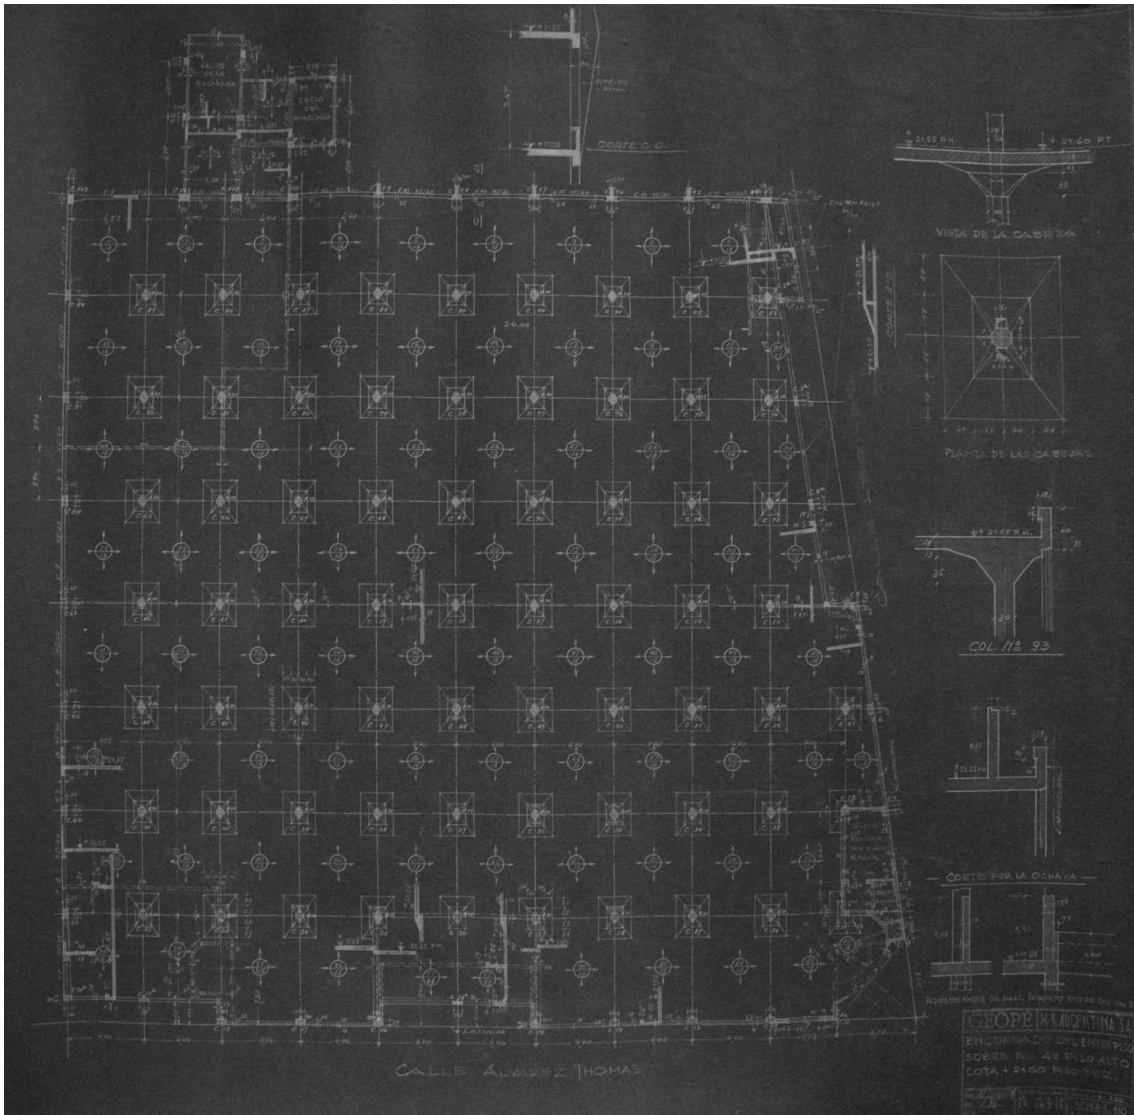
Planta da Fábrica Algodonera Argentina, no canto direito se observa os detalhes da concepção estrutural como da laje cogumelo e da viga invertida que serve de vedação. Fonte: Acervo do arquiteto Jorge Bunge do Instituto de Arte Americano y de Investigaciones Estéticas Mario Buschiazzo (IAA-FADU-UBA).
